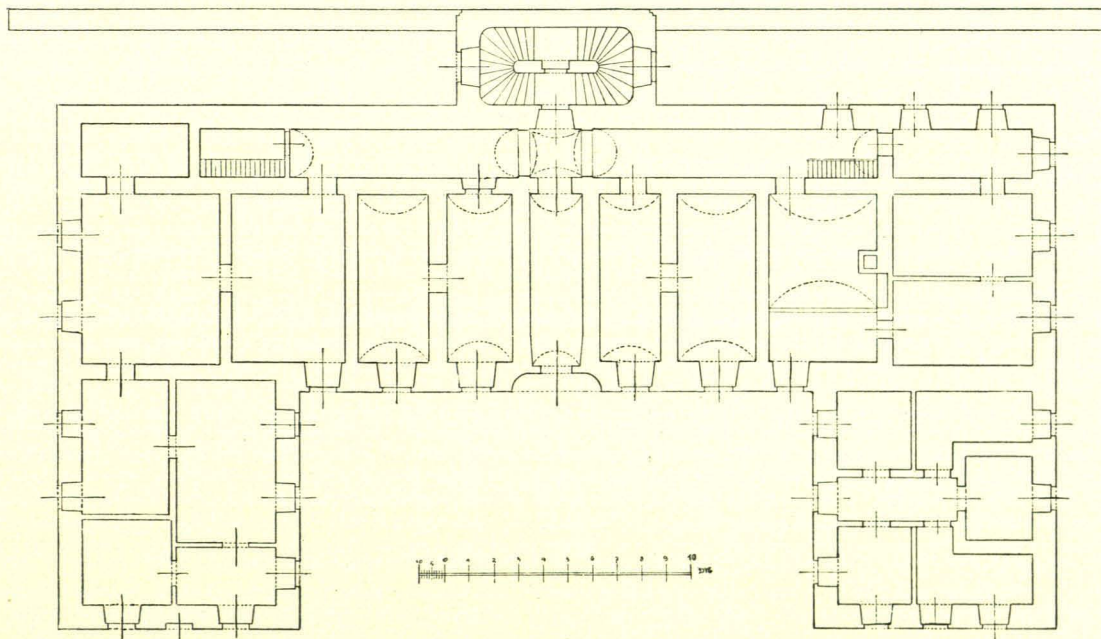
Schloß Gutenbrunn, Grundriß des Erdgeschosses, 1 : 300 (S. 43)
